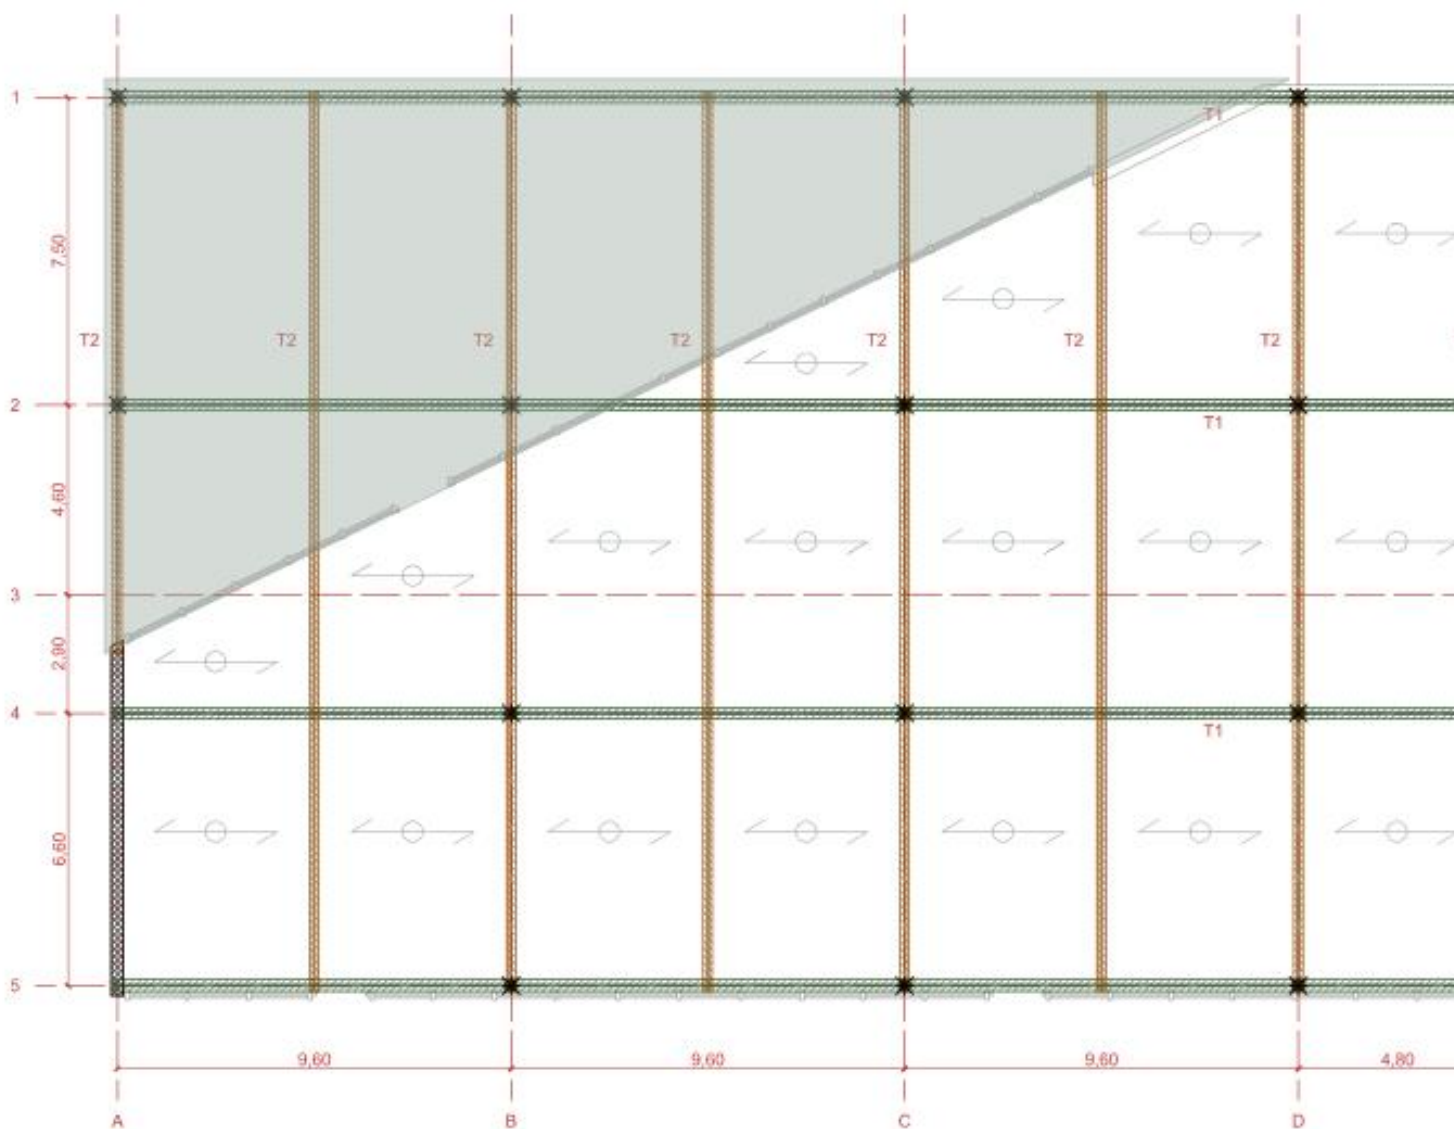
Pianta solaio piano terra edifici auditorium/museo
